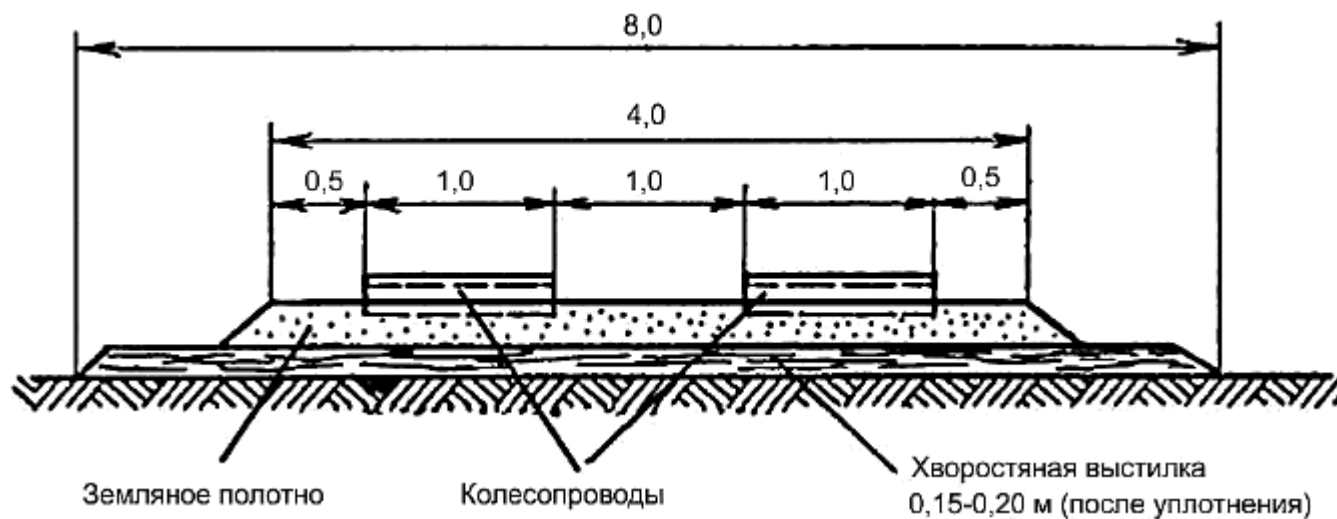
Поперечный профиль лесных дорог из железобетонных плит для условий типа местности III со слабыми грунтами, не пригодными для укладки в земляное полотно
